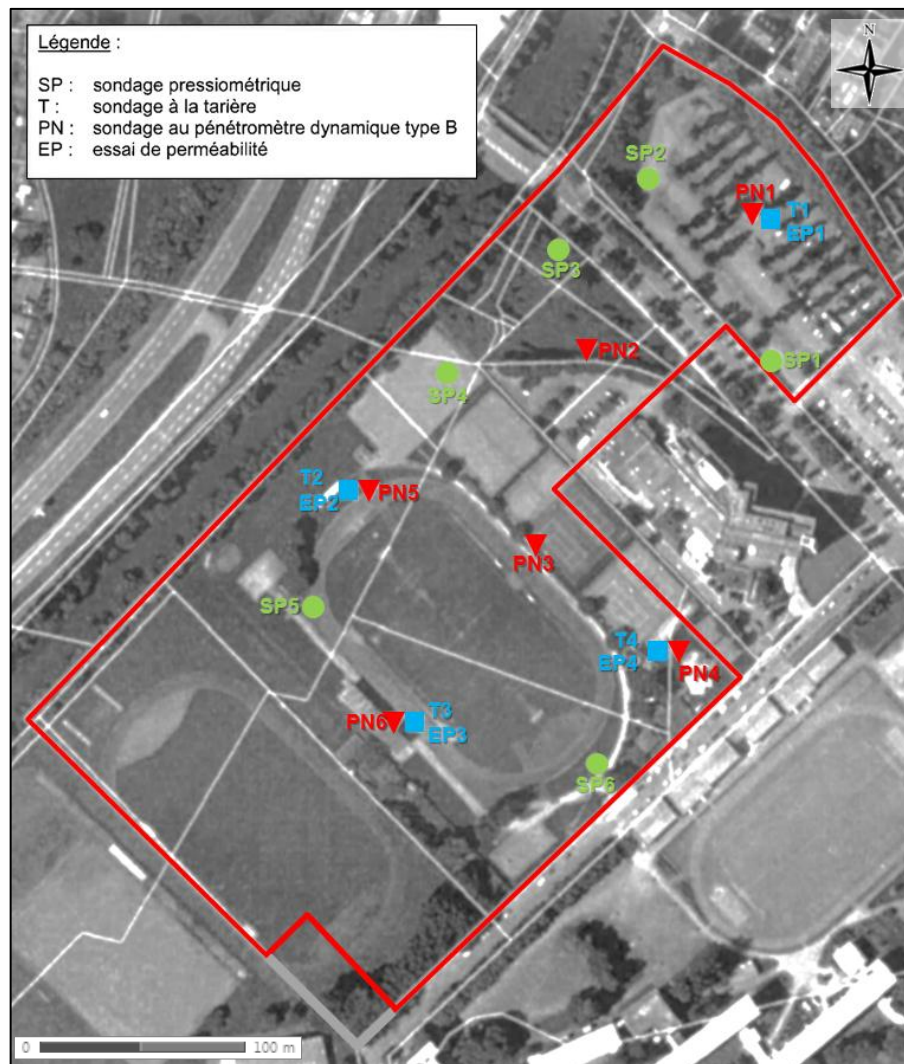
Plan d'implantation des sondages GINGER CEBTP – site PEX (février 2013)
